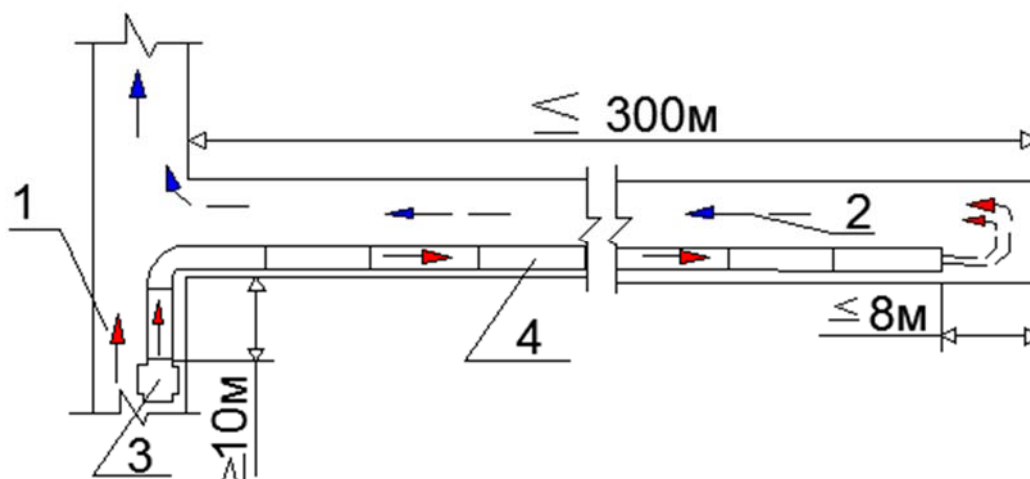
Нагнетательный способ проветривания горизонтальных и наклонных тупиковых выработок: 1 – свежая струя; 2– исходящая струя; 3– нагнетательный вентилятор; 4- трубопровод.
